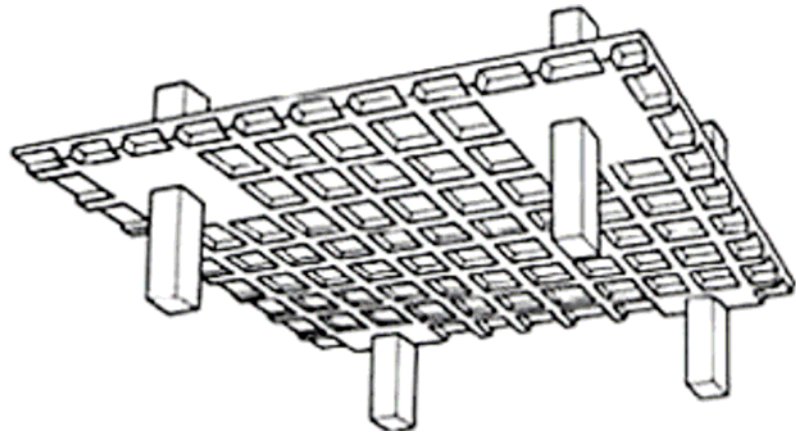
Laje nervurada lisa apoiada sobre pilares (NAWY, 1985).
